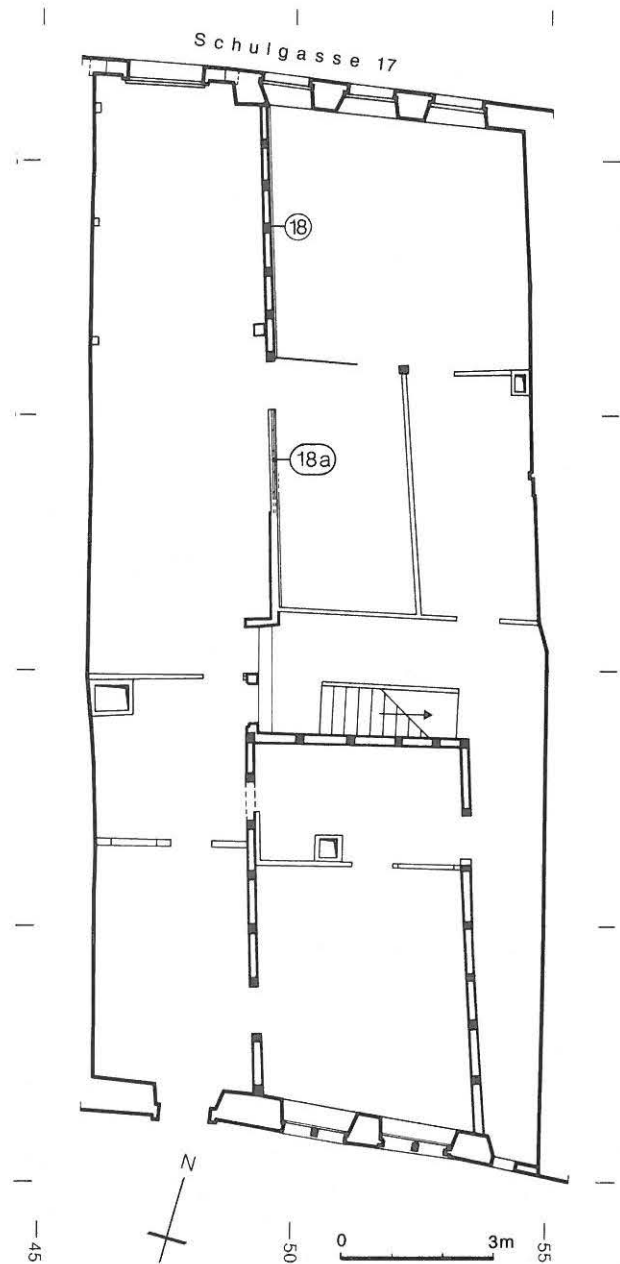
Nidau, Schulgasse 17. Grundriss des 1. Obergeschosses. M. 1:150. Legende siehe Text.
